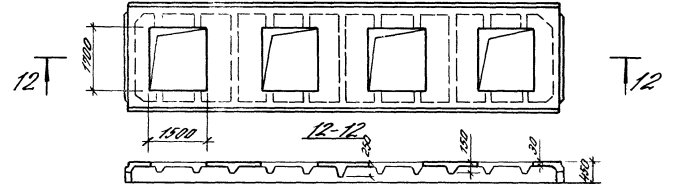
Плита типоразмера 211212 с четырьмя проемами для зенитных фонарей
